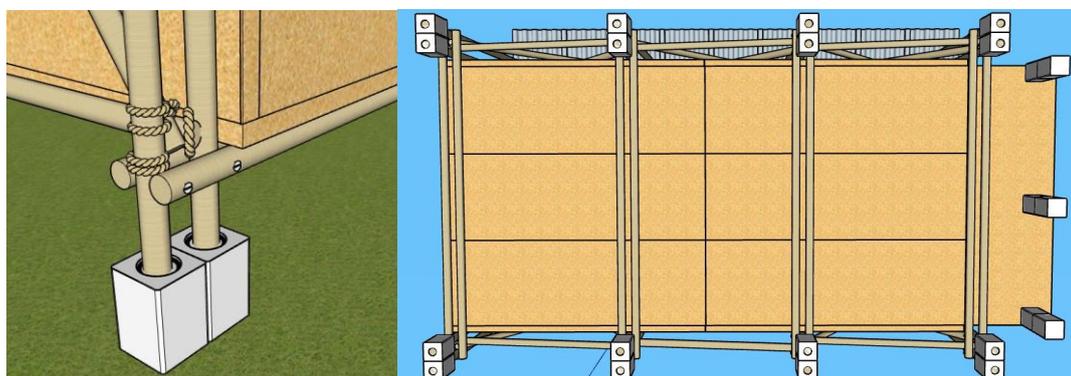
Detalhes –Peças de bambu por baixo das placas de madeira para o aumento de rigidez. Fonte: Autores, 2020
